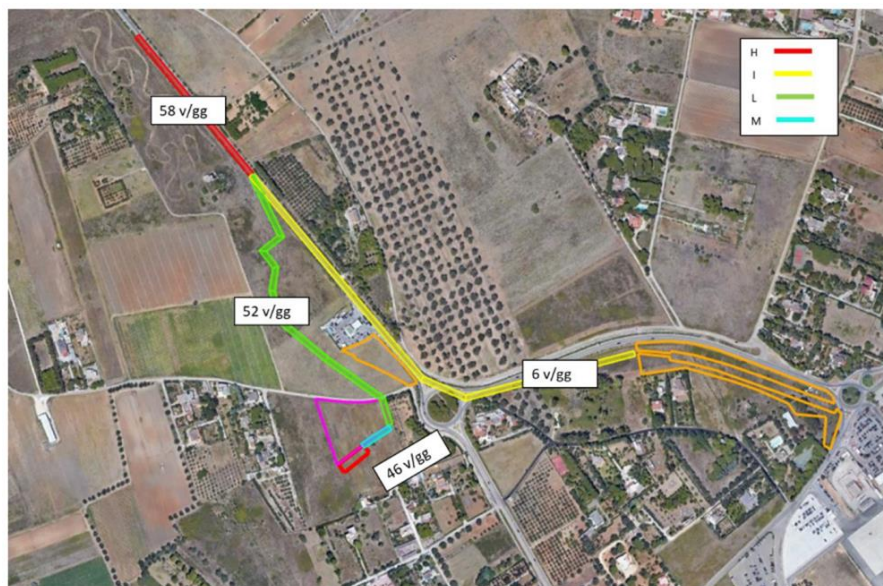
Scenario 2: Viabilità di cantiere e flussi oggetto di modellazione in Aermid View
